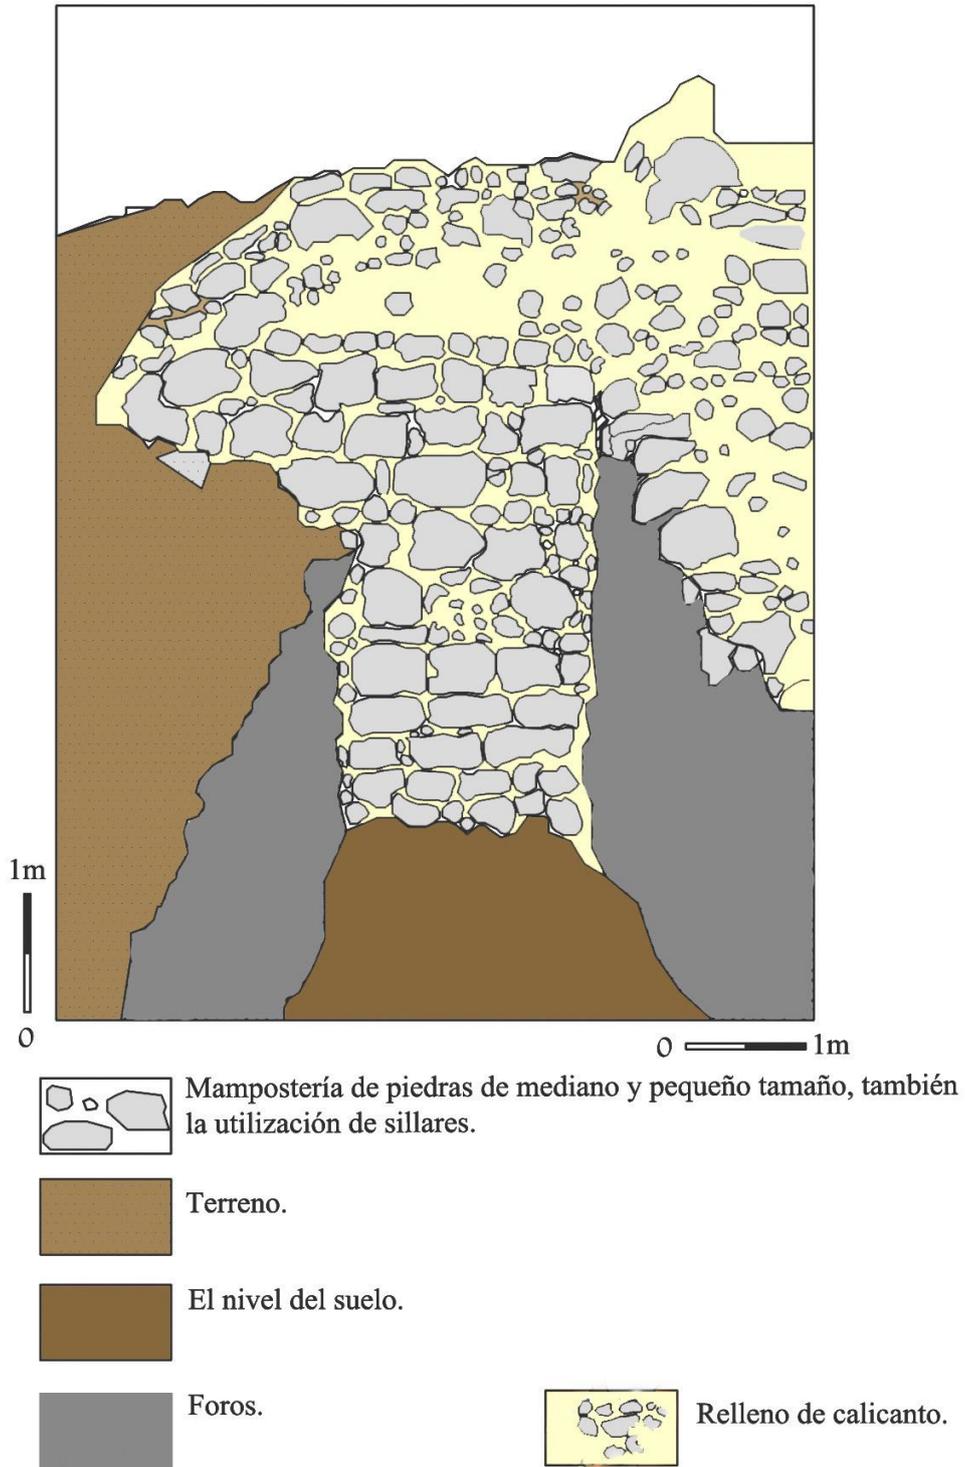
Alzado sur de la torre (T_6). Técnica constructiva tapial y mampostería de piedra caliza, con sillarejos en las esquinas. (Elaboración propia).
